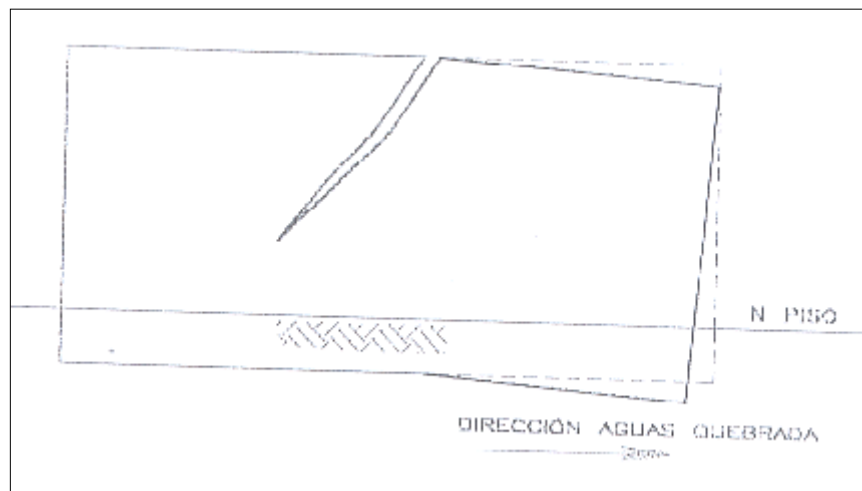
Ubicación y característica fisura en muro. Vista general
